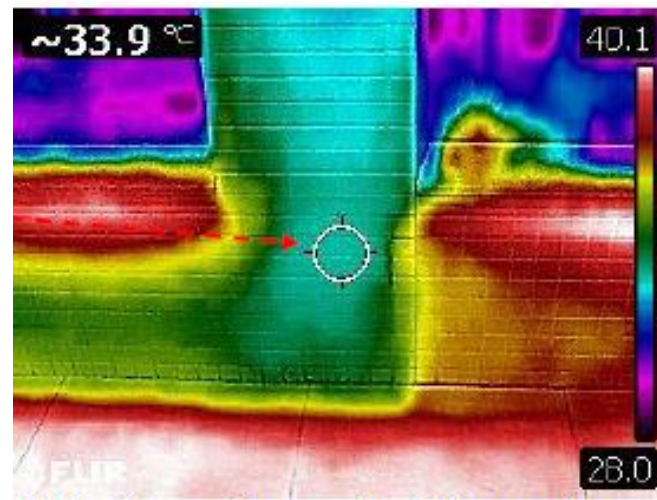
Termografia infravermelha no revestimento fissurado
